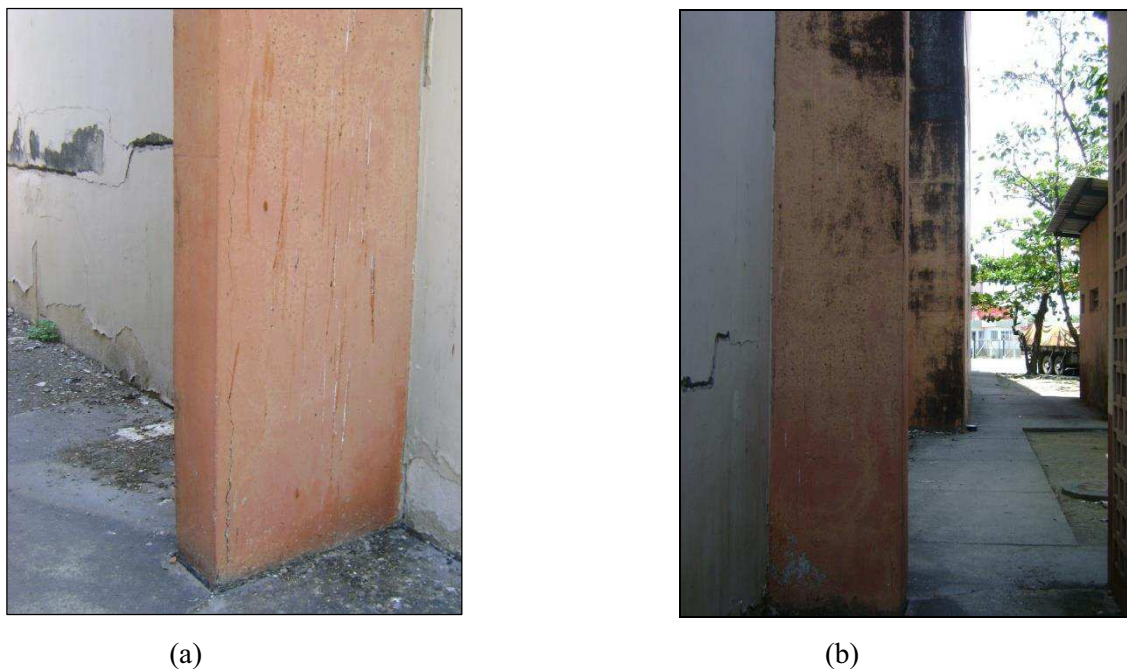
(a) Pilar P40 apresentando fissura de corrosão de armadura e (b) Pilar P40, em primeiro plano, protegido pelo prédio da subestação elétrica, com pouca presença de bolor e ao fundo, Pilar P41, fora da área de proteção das construções, com acentuada presença de bolor.
